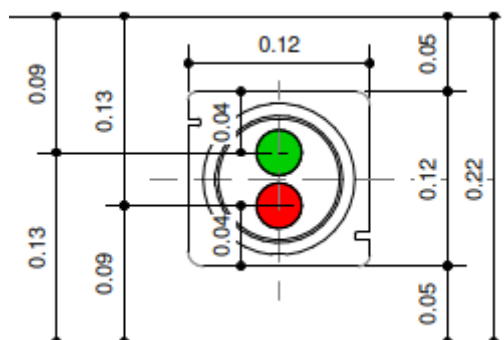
Détail de l'ancrage pour les platelages de type 3 (sur pile)
